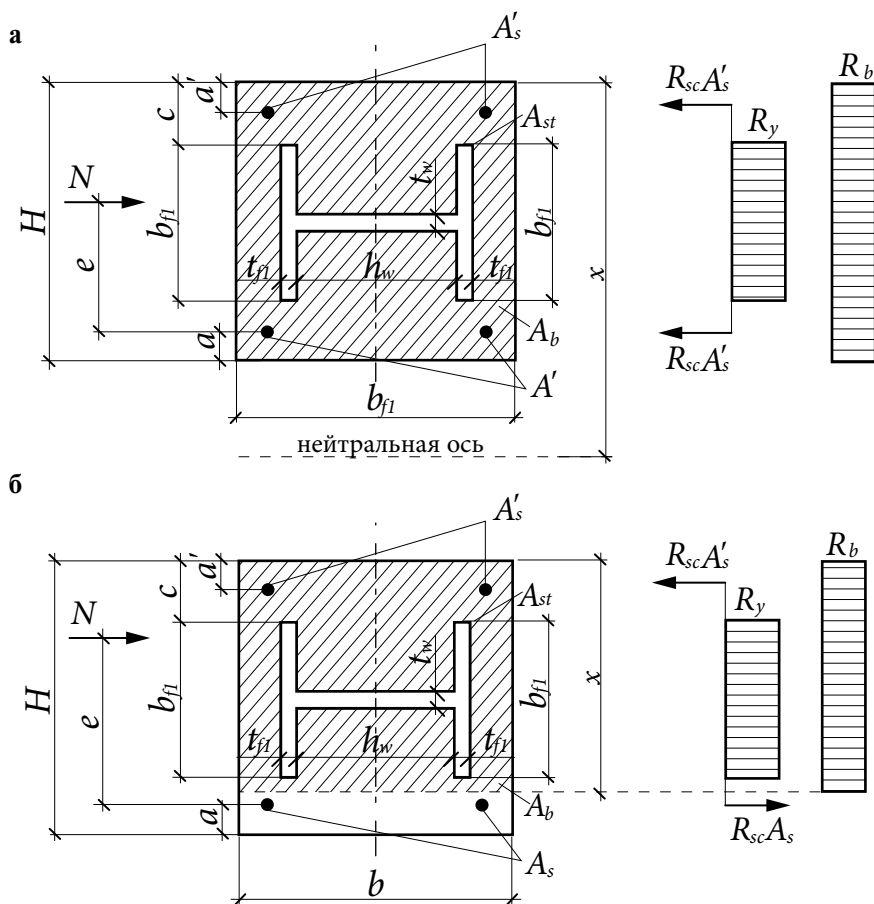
Расчетные случаи сталежелезобетонных колонн:
